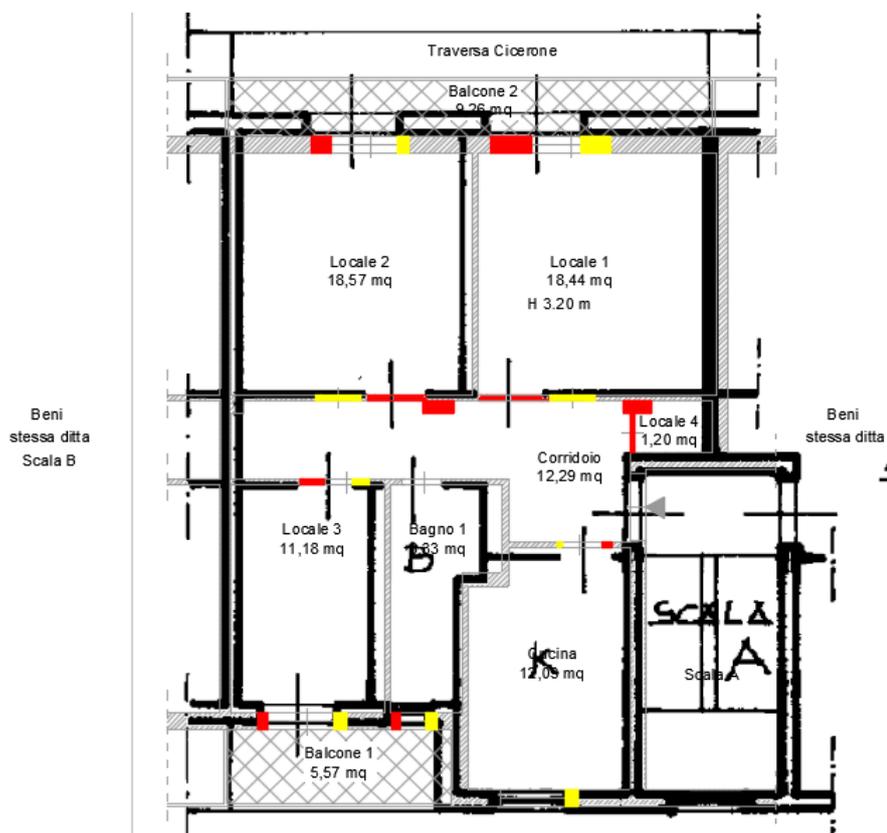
Confronto con planimetria catastale (Foglio 4, p.lla 1225, sub. 5)
